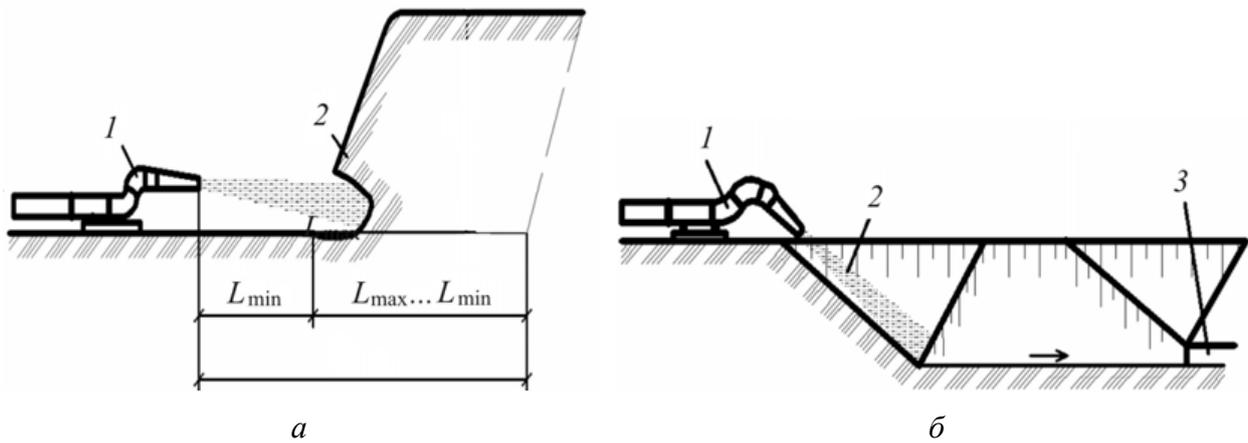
Гидромониторный способ разработки грунта: *а* — встречным забоем; *б* — попутным забоем: 1 — гидромонитор; 2 — фронт забоя; 3 — канава отвода пульпы
